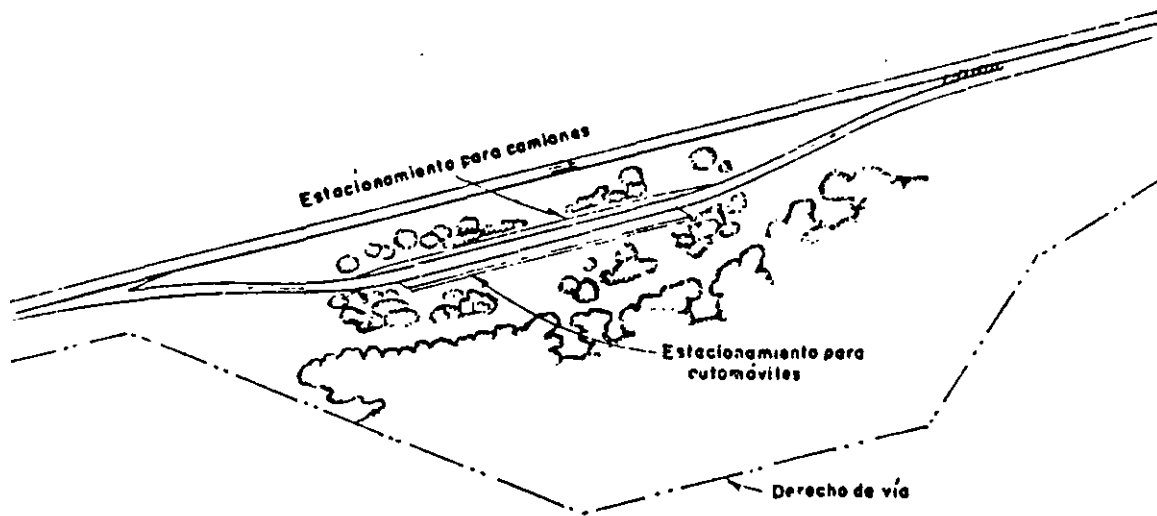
ZONA DE DESCANSO DE TIPO SIMPLE CUYO CAMINO DE ACCESO ESTA PROVISTO DE DOS FAJAS PARA ESTACIONAMIENTO PARALELO
